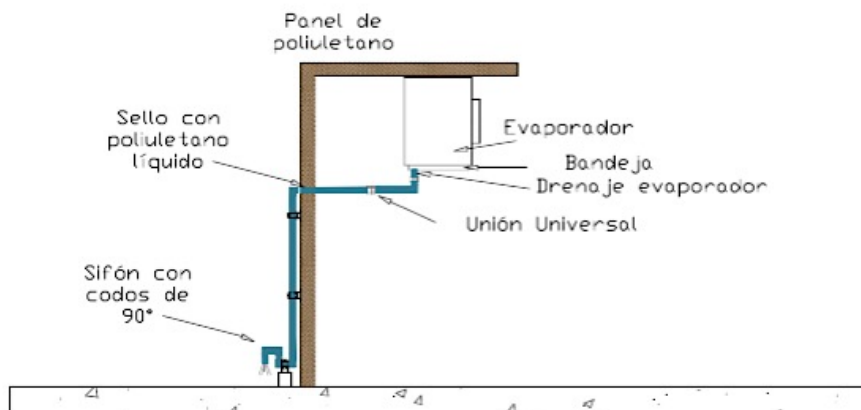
Línea de drenaje construida por una tubería de material PVC, más los accesorios conectados al evaporador
